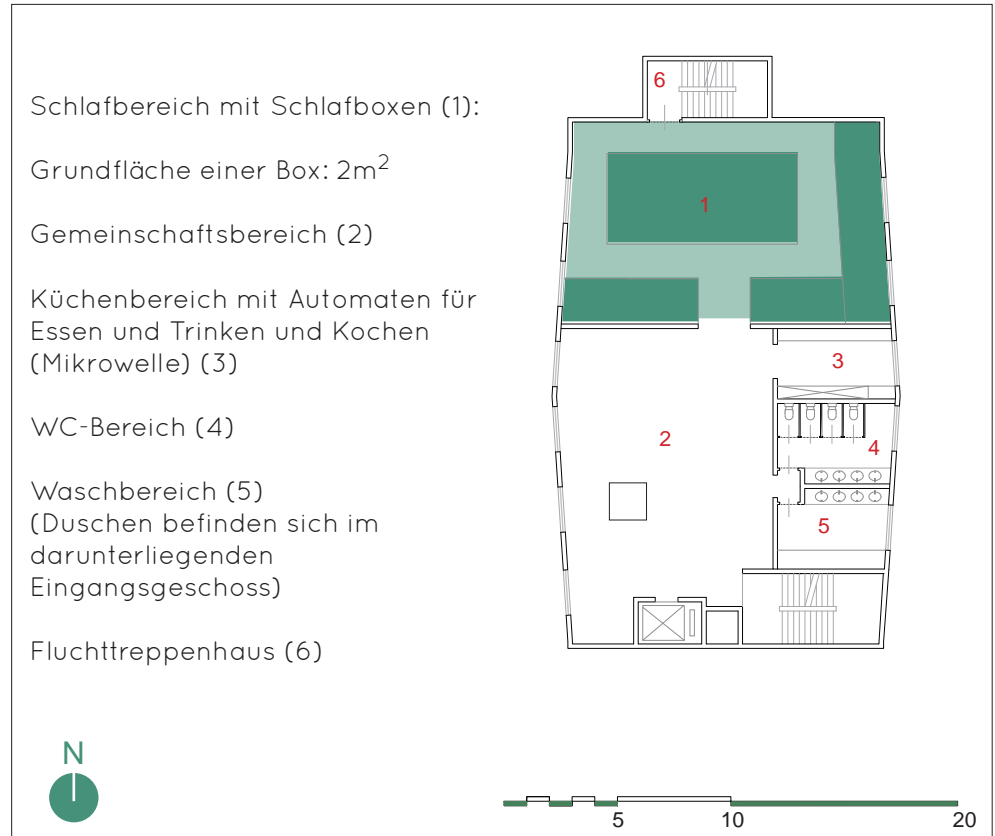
Hotelgrundriss - Sauna und Orient Hotel - OG 2
